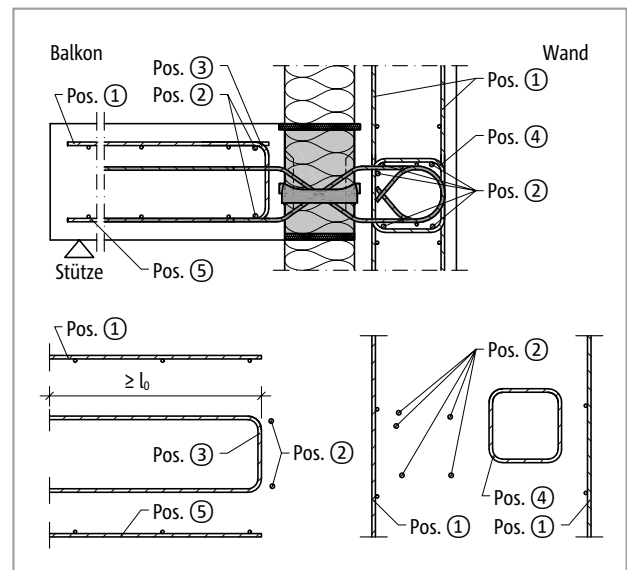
Schöck Isokorb® XT Typ Q-VV1 bis VV4 Bauseitige Bewehrung in Wand
